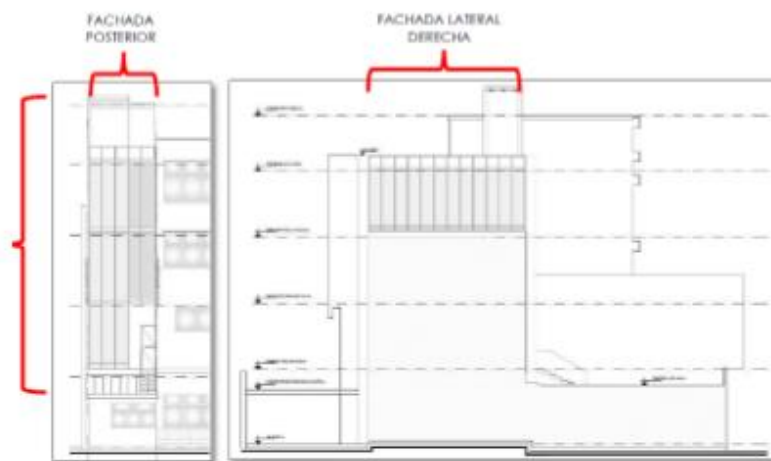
Propuesta, plano fachada posterior y fachada lateral.
